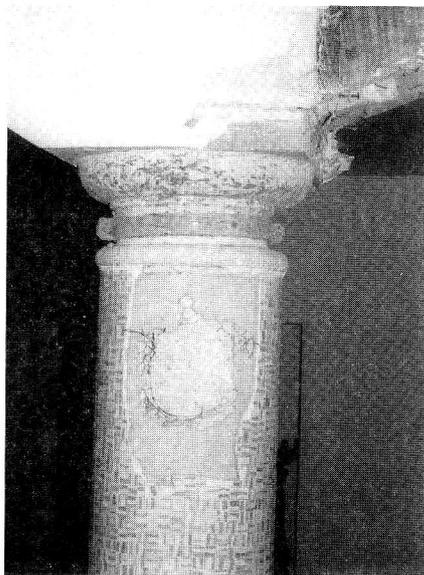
San Blas 8. Una de las columnas toscanas instaladas en la planta baja.
